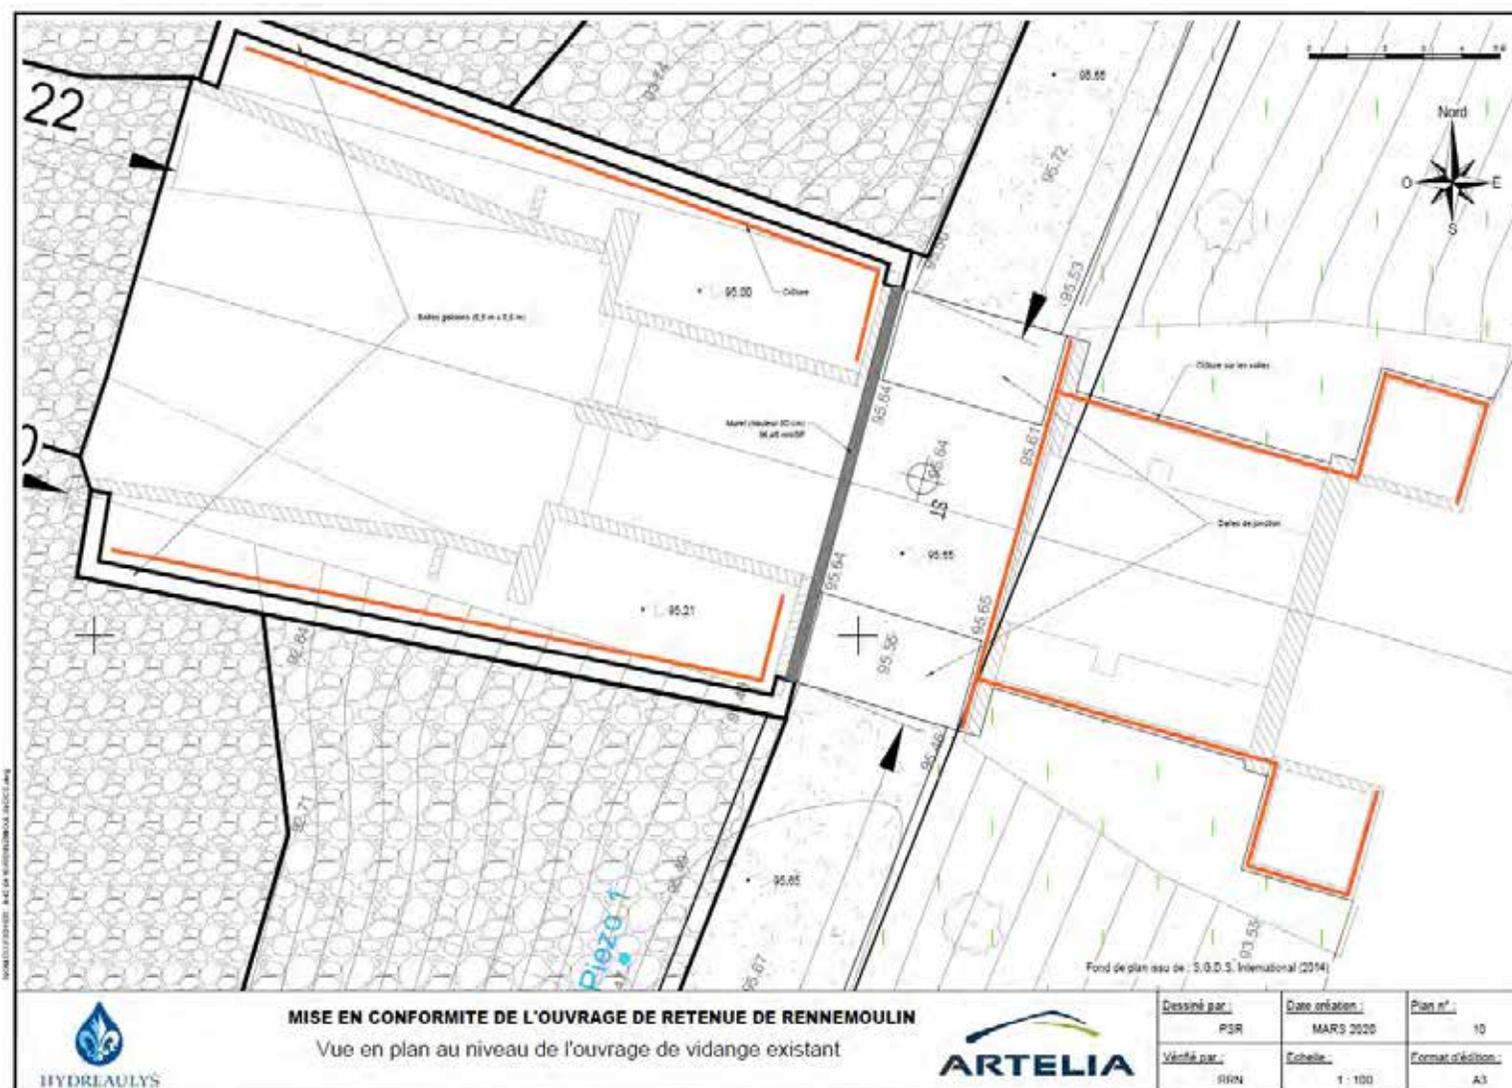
Vue en plan de l'ouvrage de retenue en l'état projet
